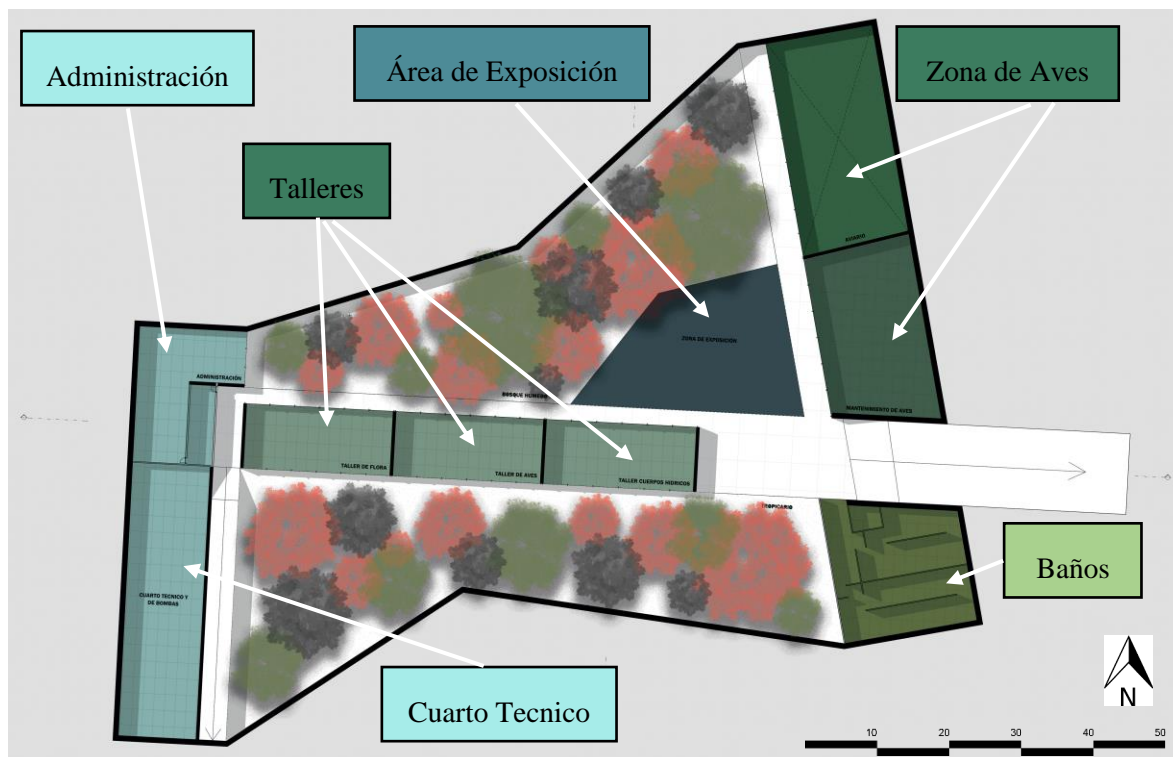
Planta primer nivel soterrado (N.P.T -6.00M). Elaboración propia.
